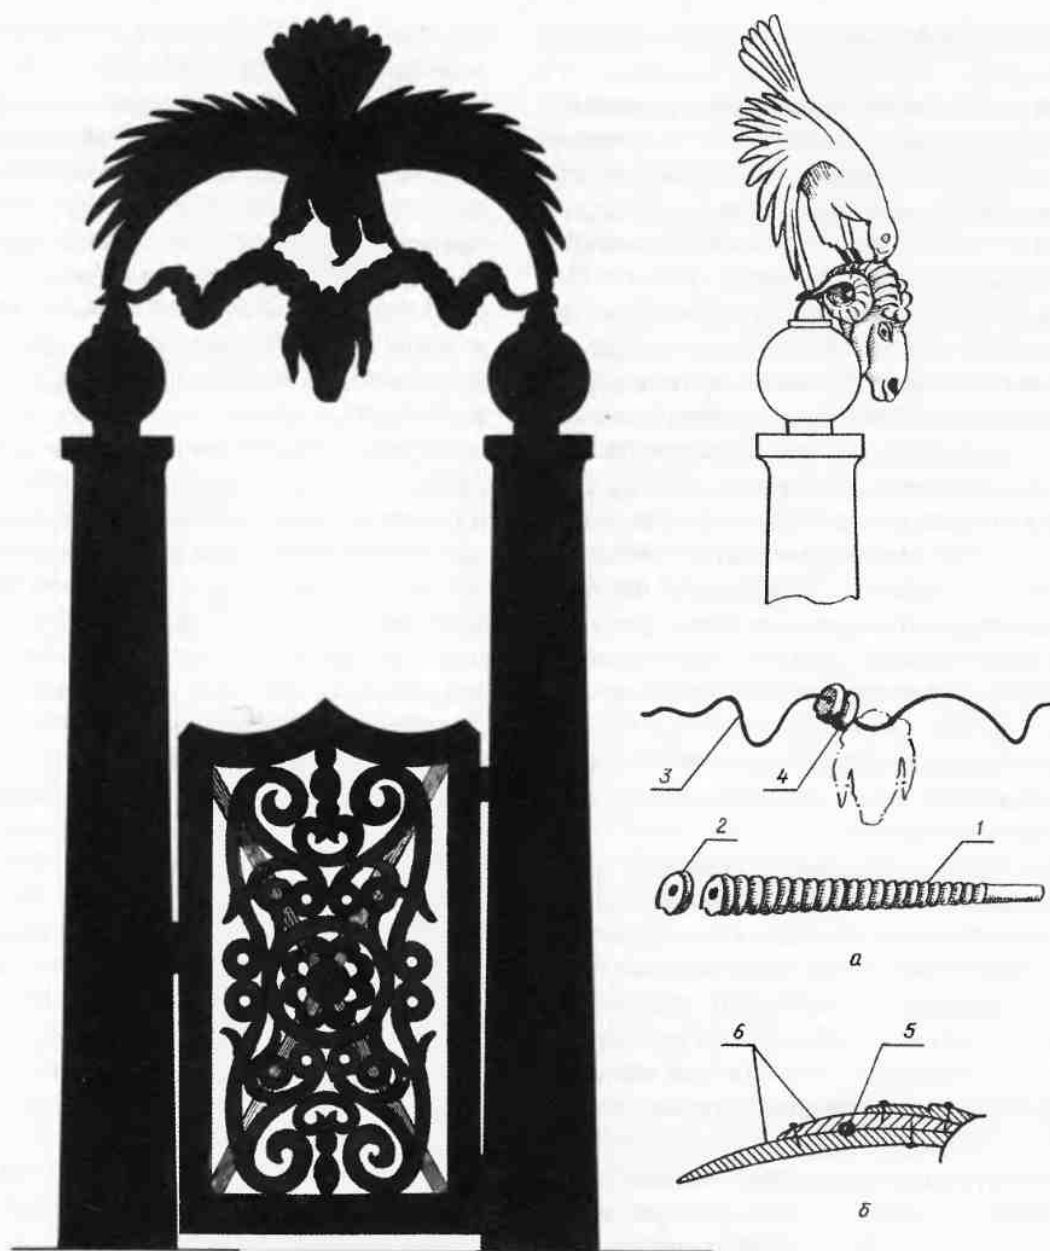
Арка для калитки шириной 80—100 см с накладным орнаментом из двух досок шириной 27—34 см. Вид слева арки. Конструкция рогов барана (а) и крыла орла (б): 1 — деревянная заготовка для отпиливания колец; 2 — отпиленное кольцо; 3 — труба, изогнутая по форме рогов; 4 — кольцо, насаженное на трубу; 5 — изогнутая труба, проходящая через крыло; 6 — доски «перья» крыла
